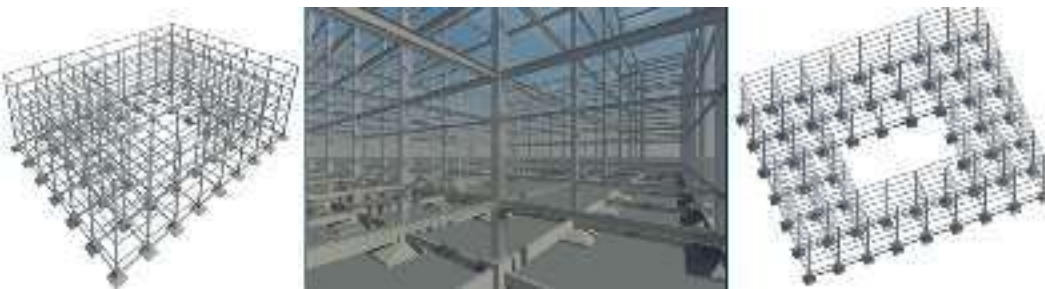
SE OBSERVA LA ESTRUCTURA QUE SE UTILIZARÁ PARA LA EDIFICACIÓN
